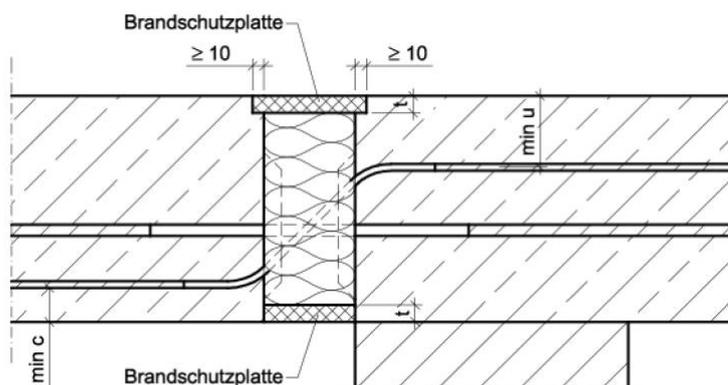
Schöck Isokorb® Typ Q mit SCE
